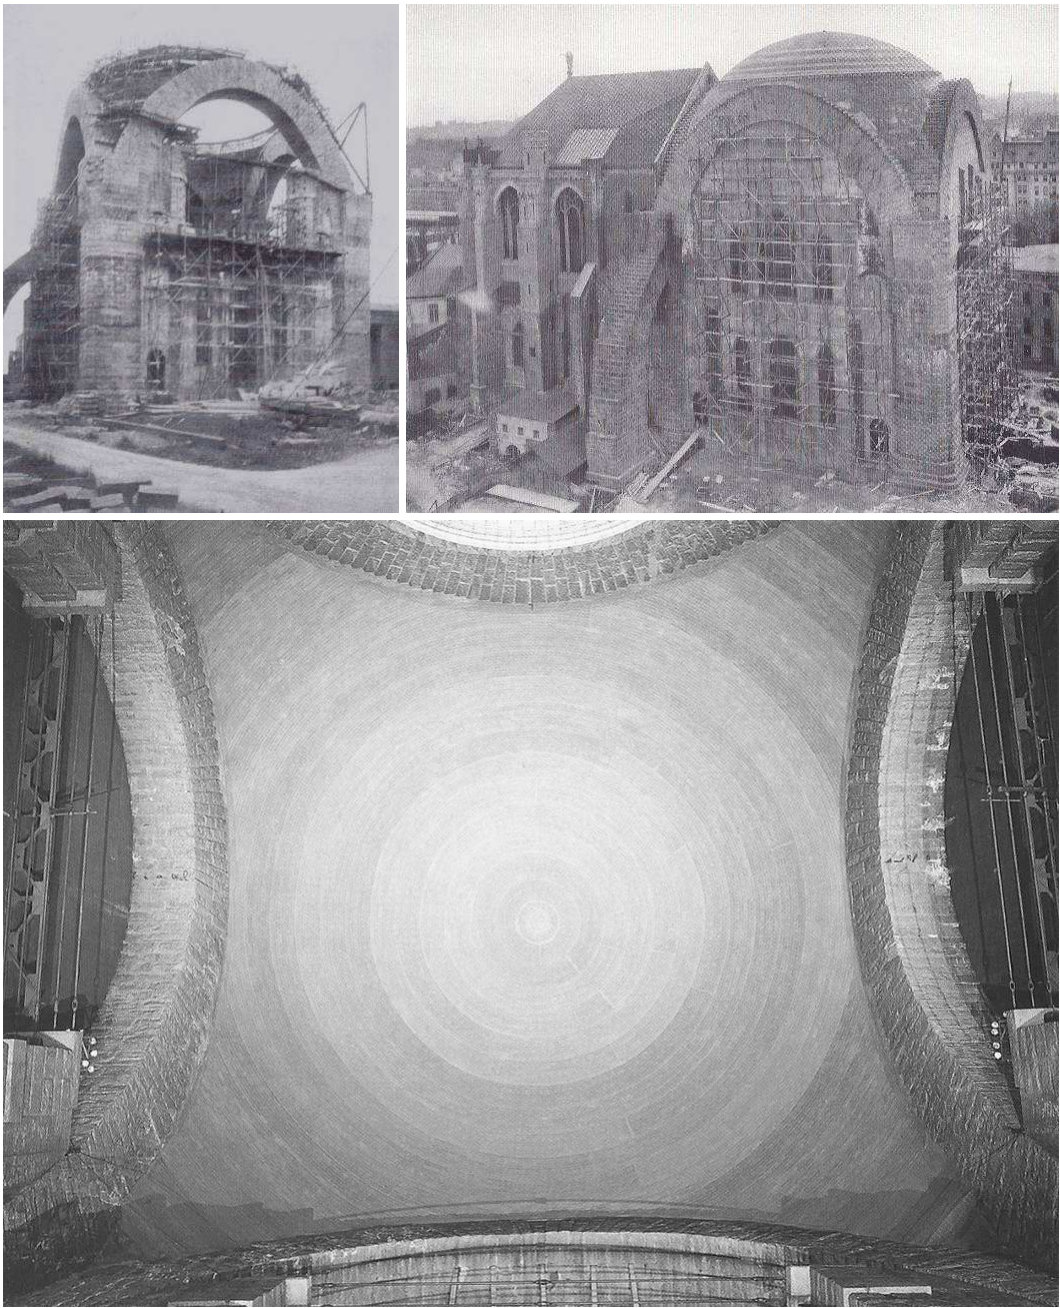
a | b | c Vista exterior de distintas fases del proceso de construcción de la cúpula y vista interior en planta de la cúpula central ya terminada de la Catedral de St. John the Divine, en Manhattan, Nueva York (1892-1932)
